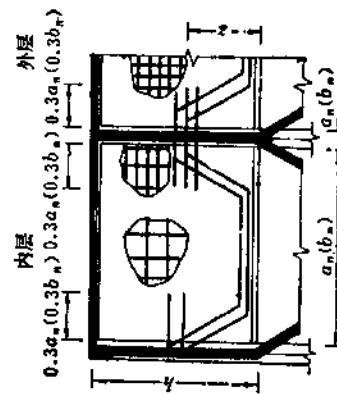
高壁浅仓和深仓仓壁集中配筋示意图
